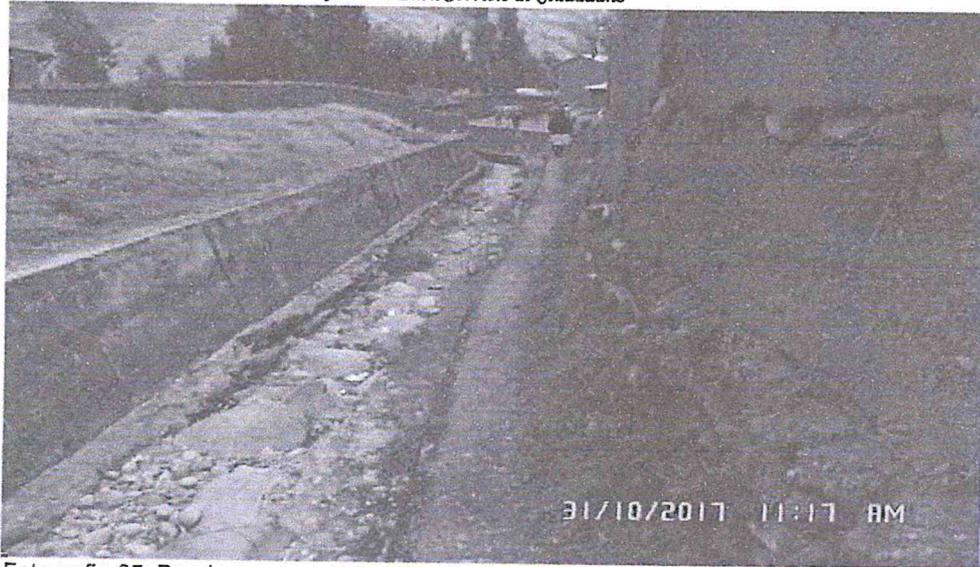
Donde se aprecia la invasión de viviendas hasta el muro de contención sin respetar el ancho mínimo de la faja marginal.
